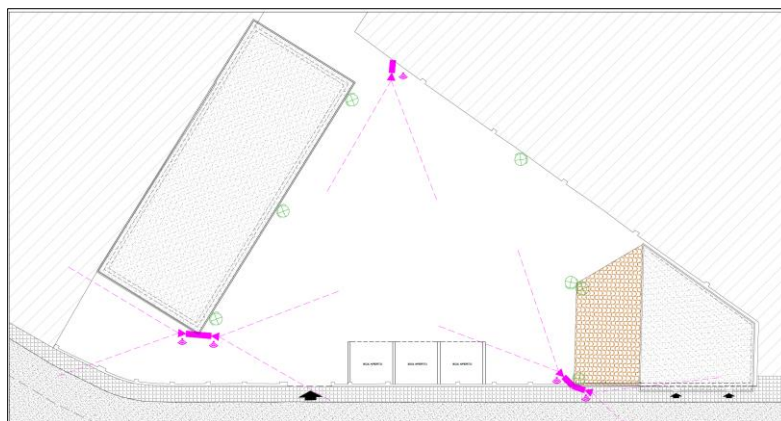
Planimetria generale: impianto di illuminazione e di videosorveglianza
